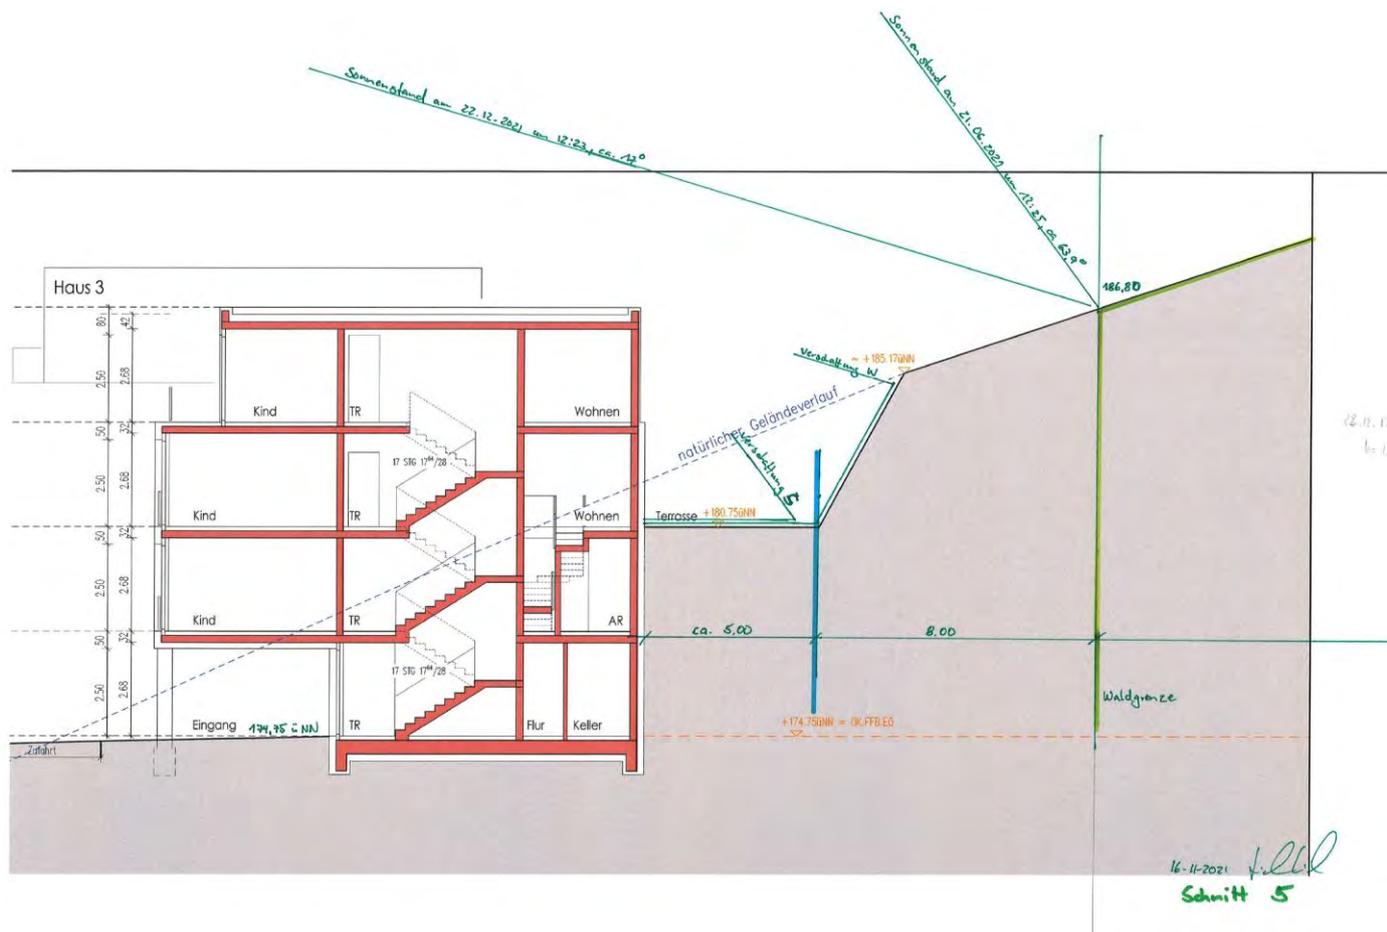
Schnitt durch die geplante Bebauung mit Sonnenstand am Waldrand (Architektur-Loft, Weinheim, übermittelt im November 2021)
